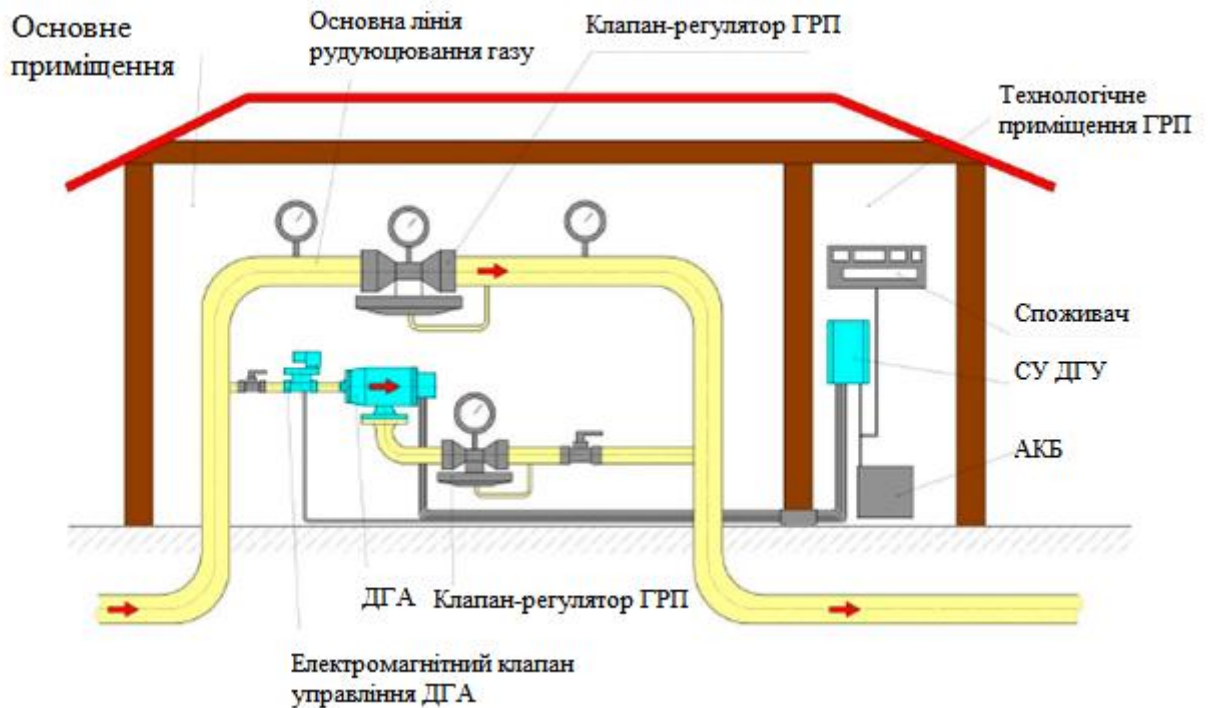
Схема розміщення детандер генераторного агрегату ДГА-К-0,3
